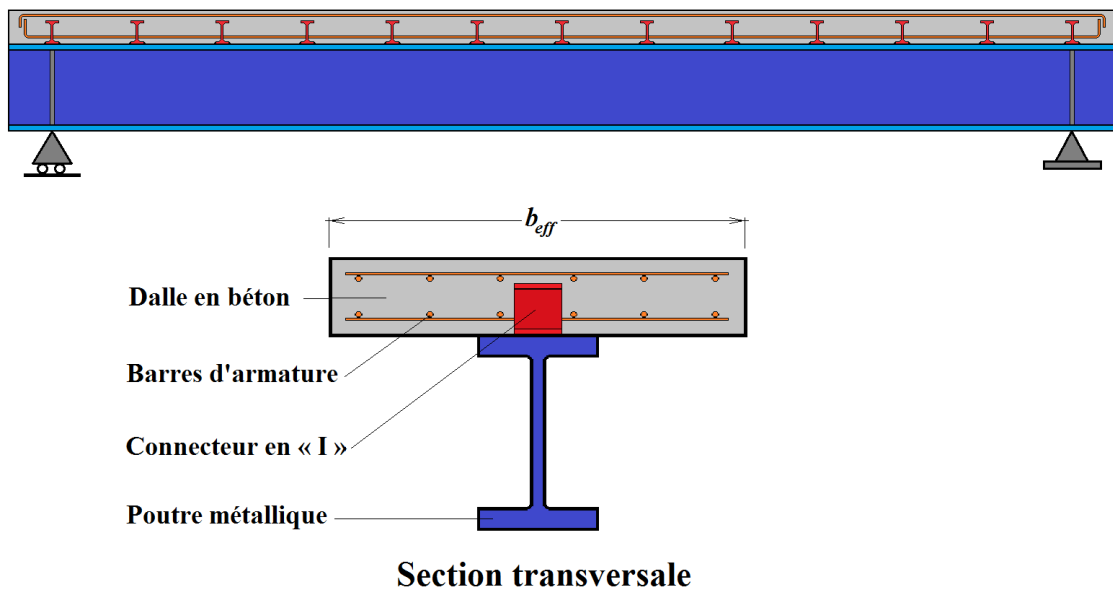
Poutre mixte avec des connecteurs en « I »
